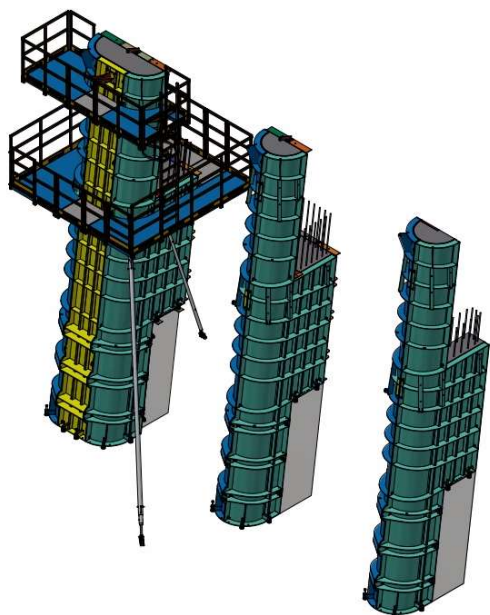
Bekisting voor de pergolawanden met houten elementen voor de profilering
